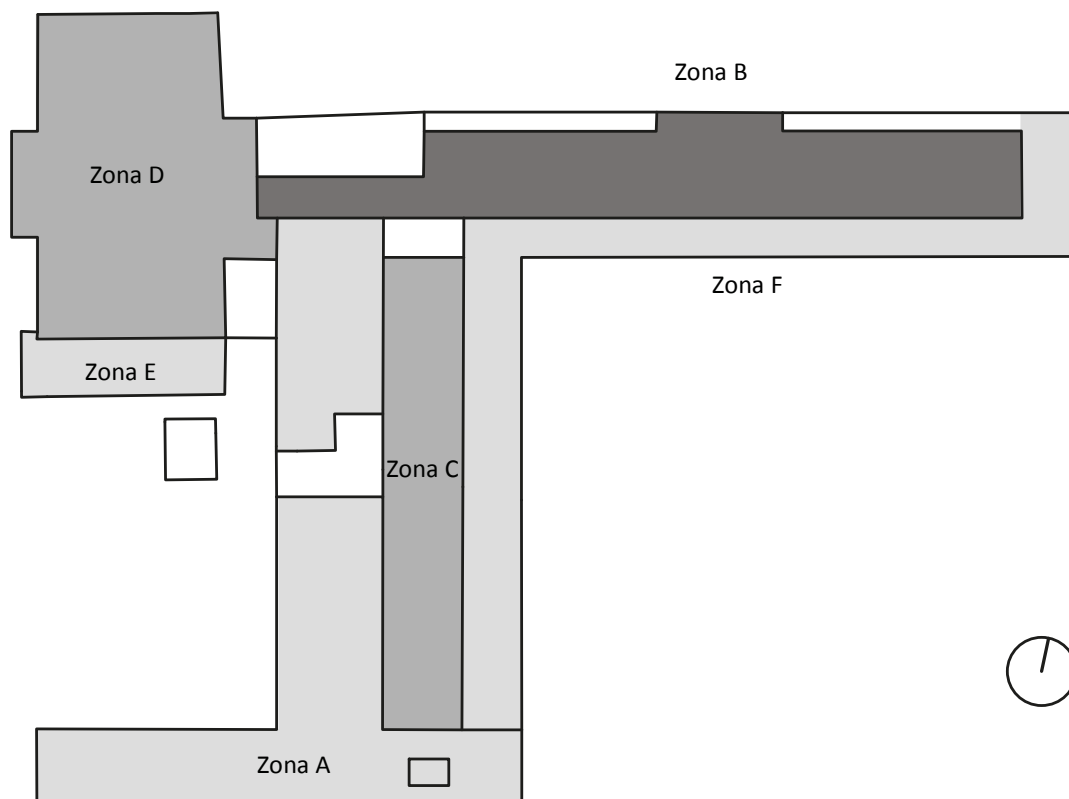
Plano de cubiertas Rectorado Edificio A
